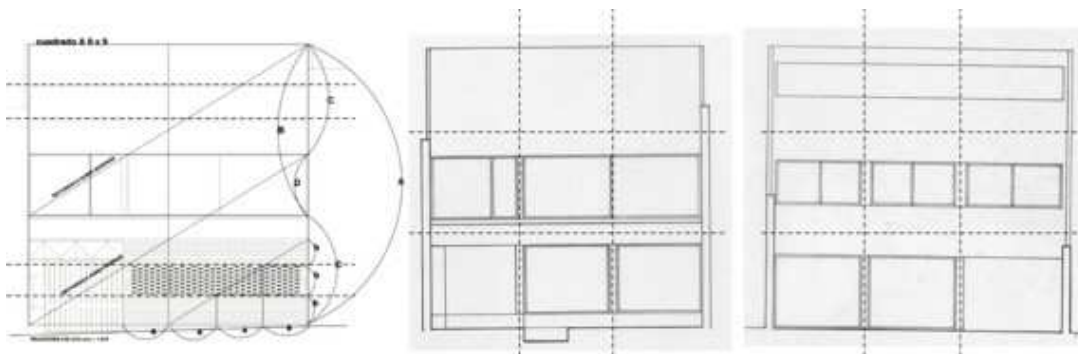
Da esquerda para direita: Fachada Frontal Sul com mural à frente, Fachada Frontal Sul e Fachada Posterior Norte da Casa Gimeno.
